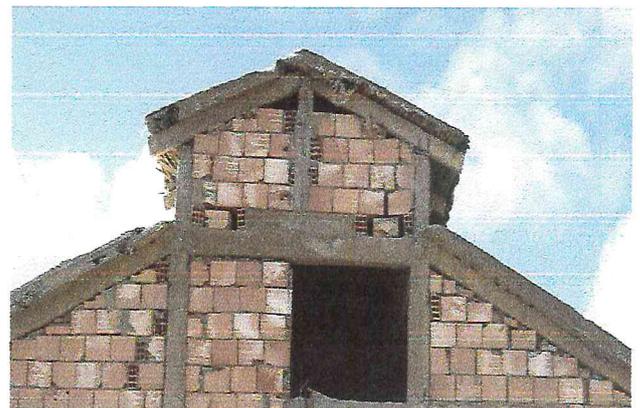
la toiture du bâtiment (photo personnelle, 2013).
